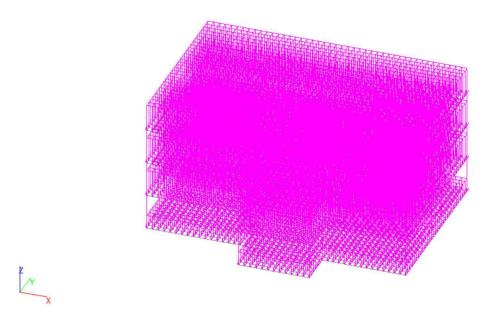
Общий вид постоянного загружения перекрытия от собственного веса плиты и конструкций пола
